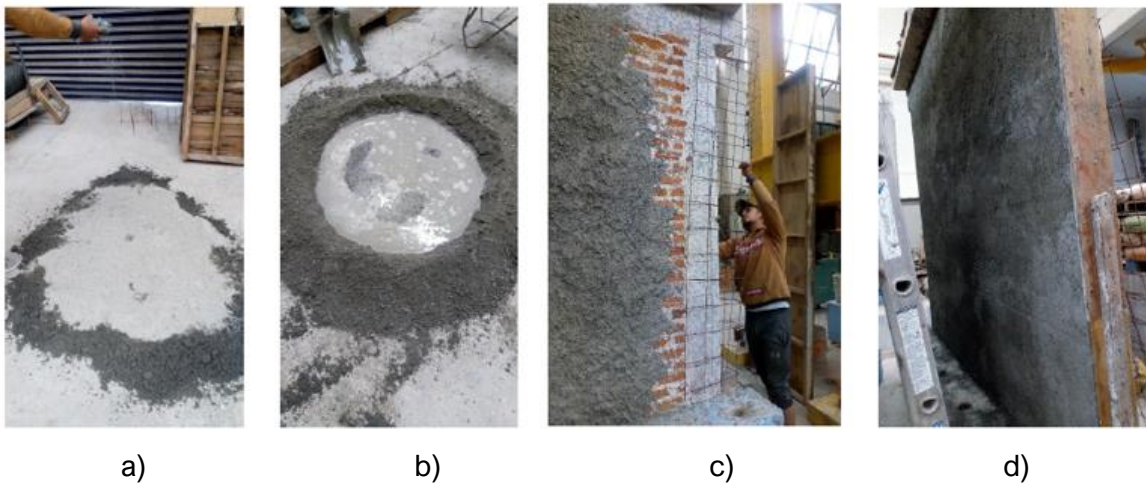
Procedimiento constructivo de rehabilitación de muros de mampostería empleando mortero reforzado con fibras de acero (Lubin, 2021).
